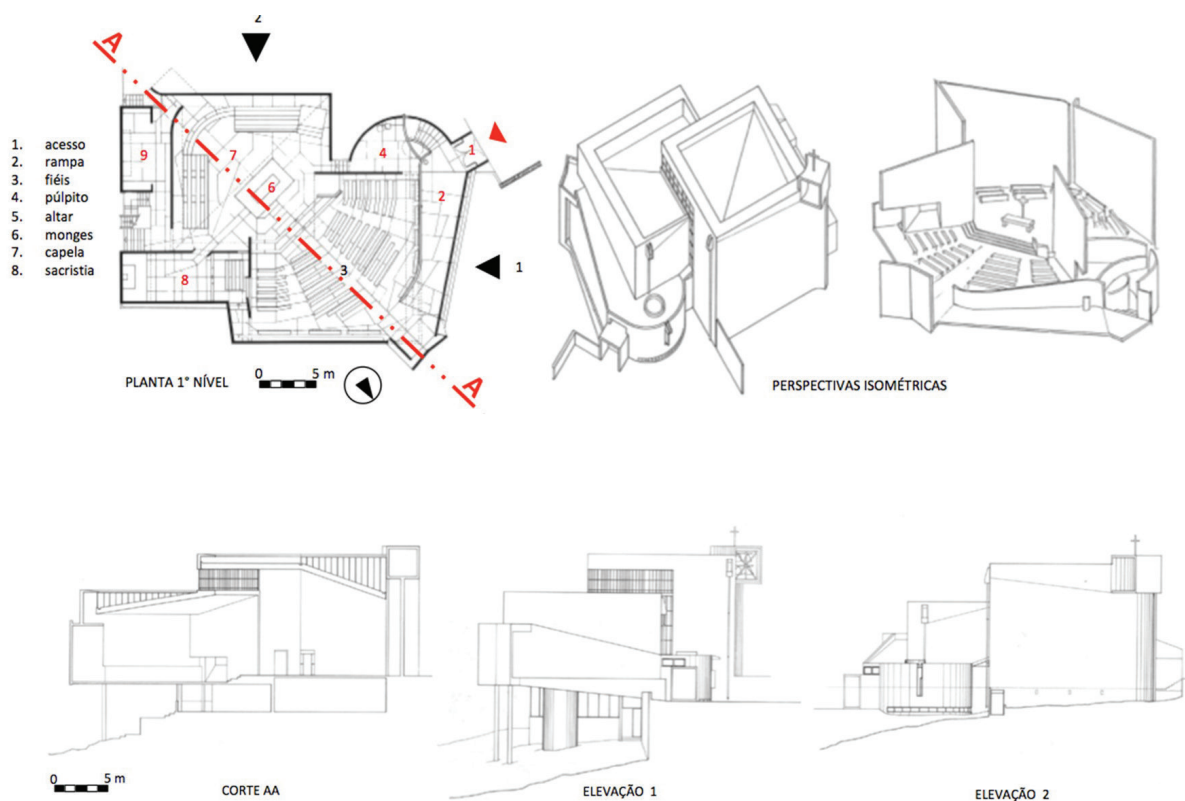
Projeto. Planta baixa e isometrias (externa e interna).
